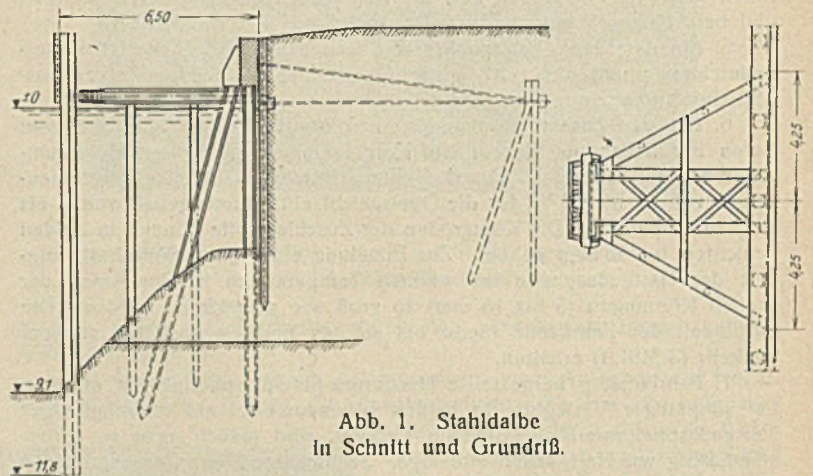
Stahldalbe in Schnitt und Grundriß.
